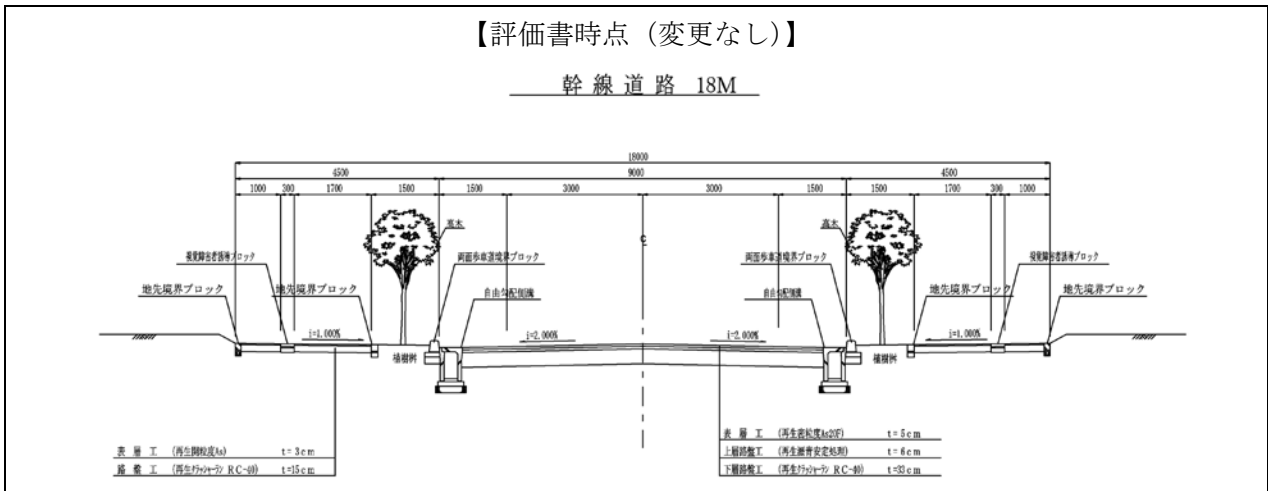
(1) 道路断面図(幹線道路:18m 標準断面)
